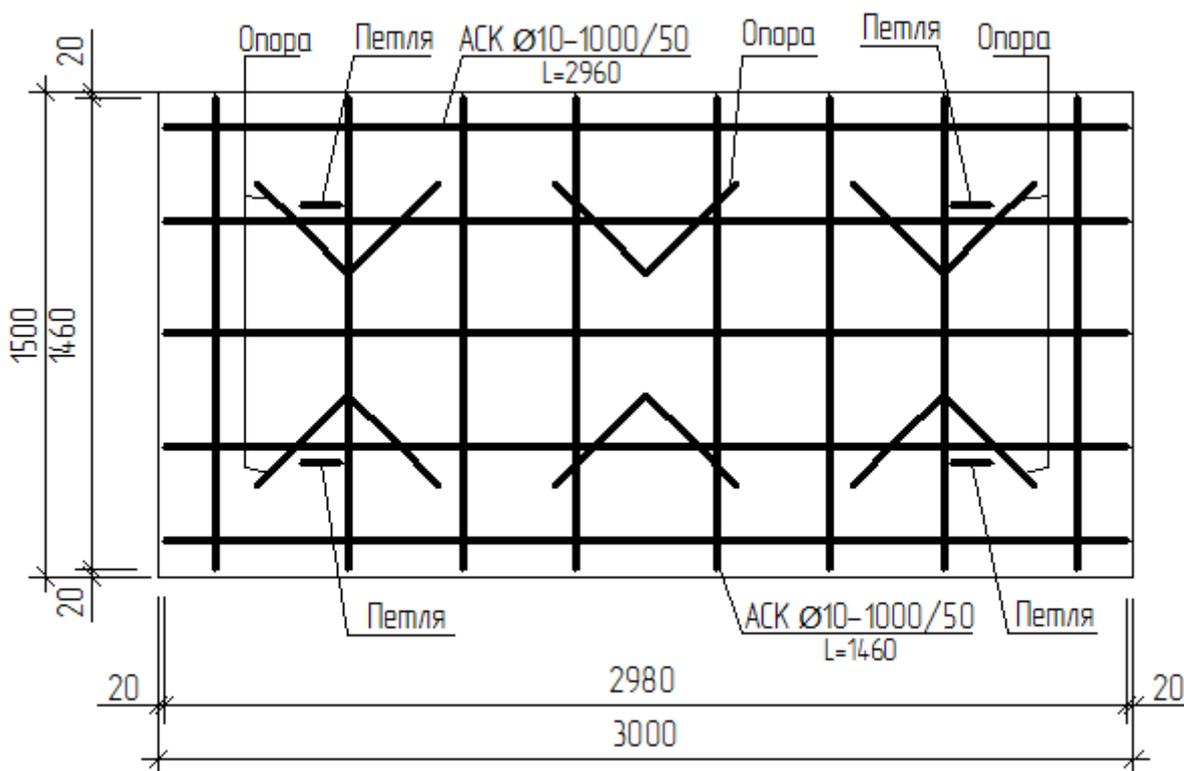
Армирование дорожной плиты ПД 30-15-18;
